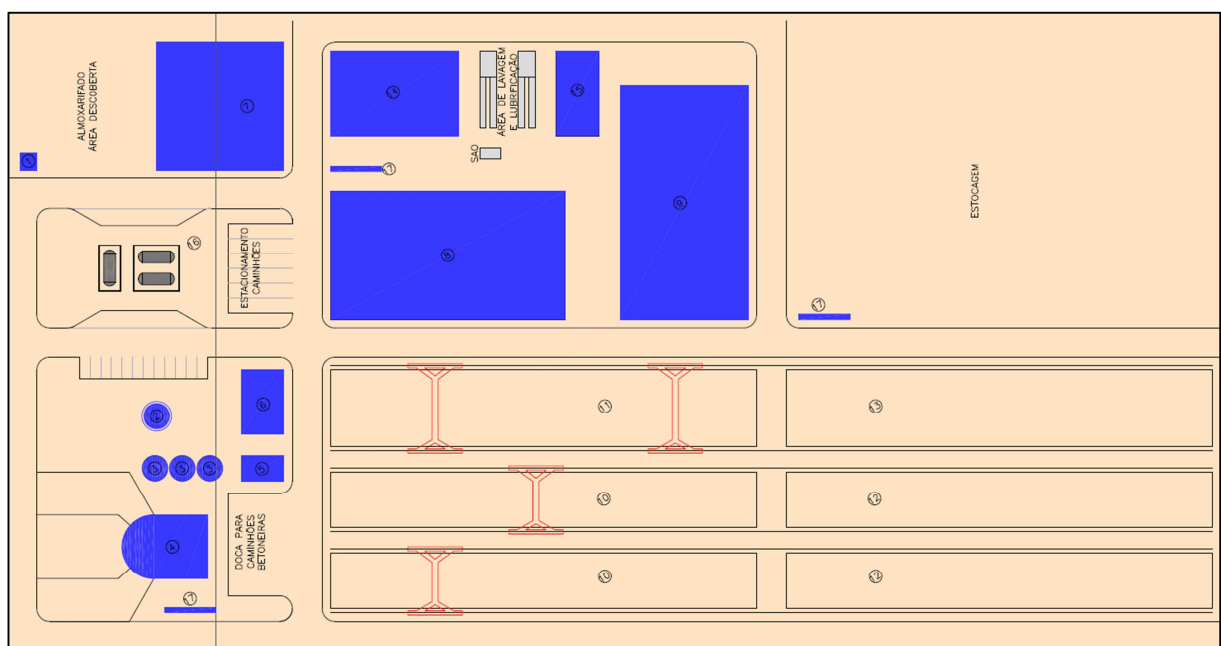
Arranjo do Canteiro Avançado – Alternativa 1.
